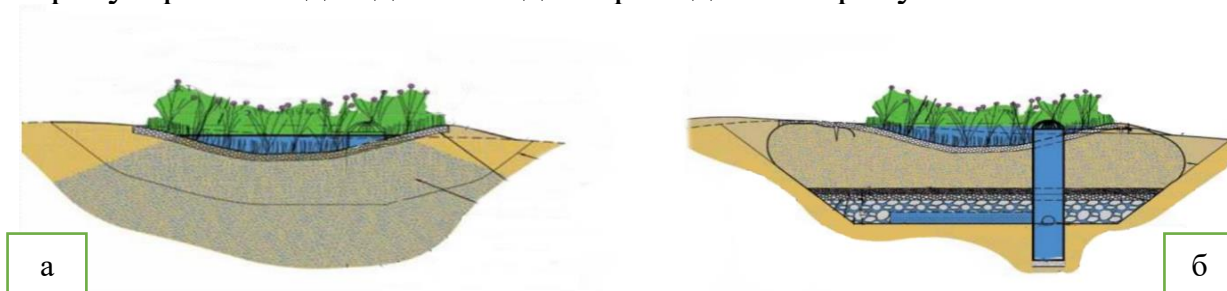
Схемы устройства дождевых садов (а – на фильтрующем грунте, б – с дренажом)
